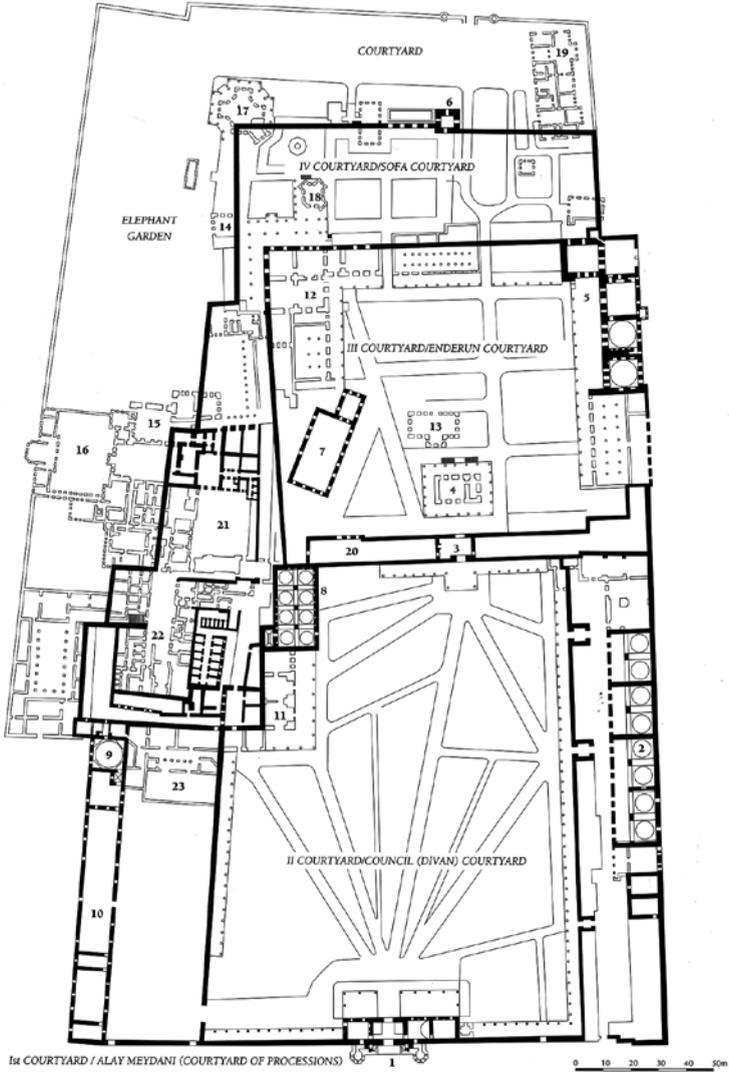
Grundriss des Topkapı-Palasts
